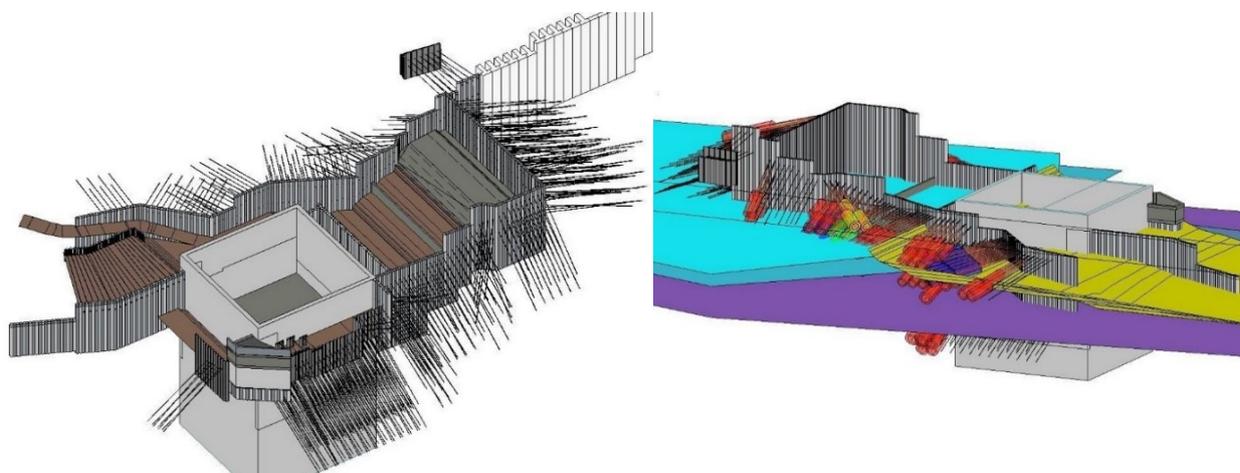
Baugrubenmodelle im Autodesk Revit mit Baugrundsichten und Ankerkollisionsprüfung
